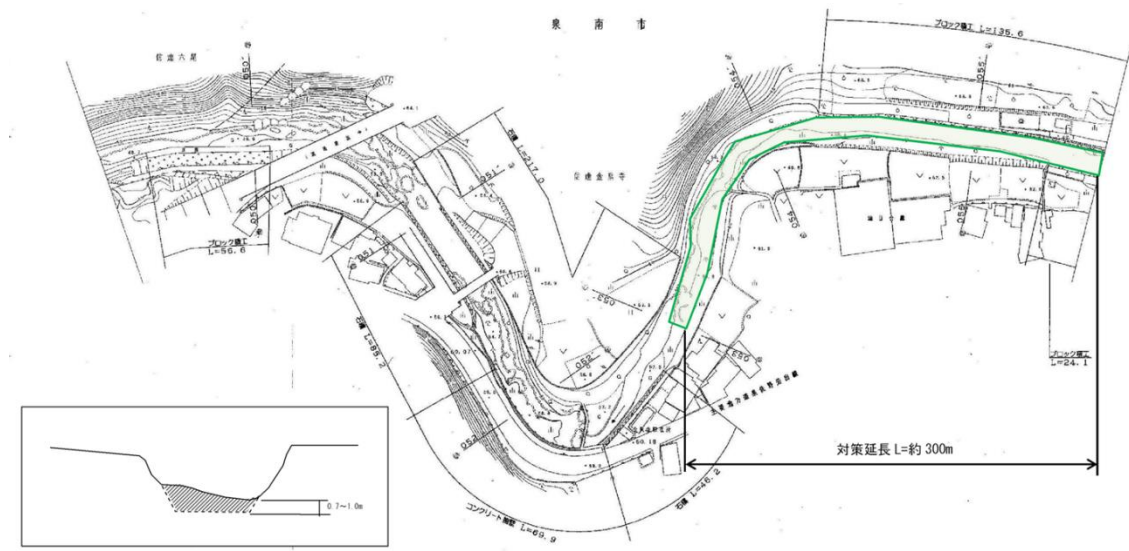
信達金熊寺地区付近 (5.3km~5.6km 付近) 平面図
